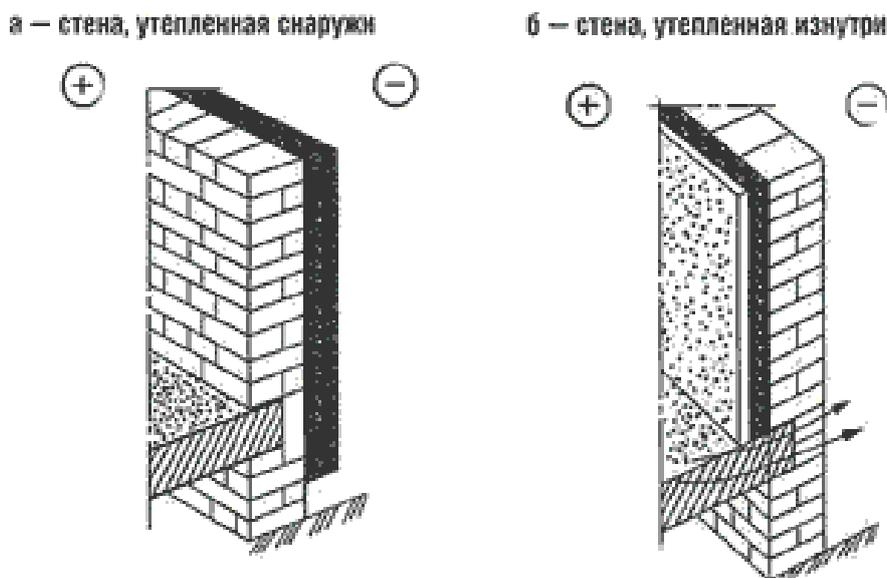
Варианты наружного и внутреннего утепления наружных стен.
